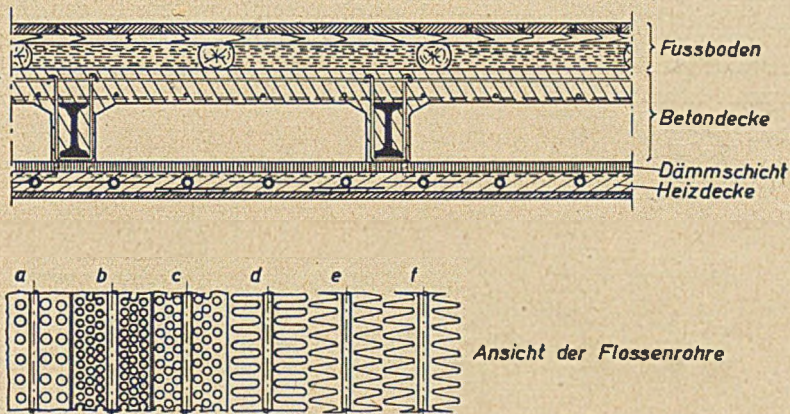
Stahlbetondecke mit Flossenrohrbeheizung.
